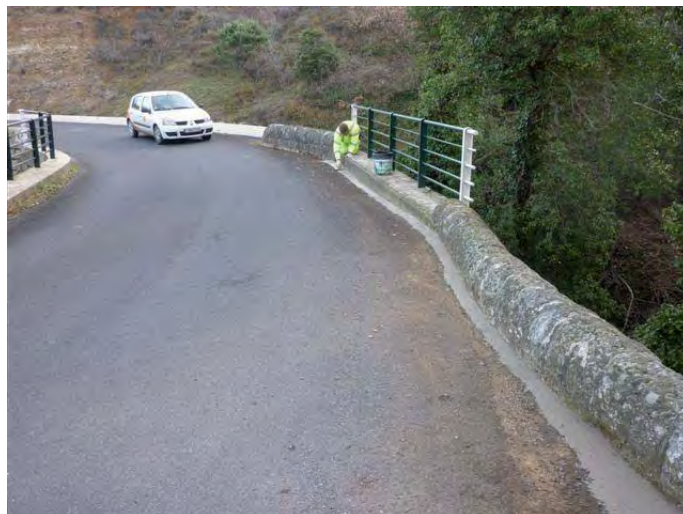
St-Paul, bétonnage pied de mur pour éviter la pousse d'herbe
